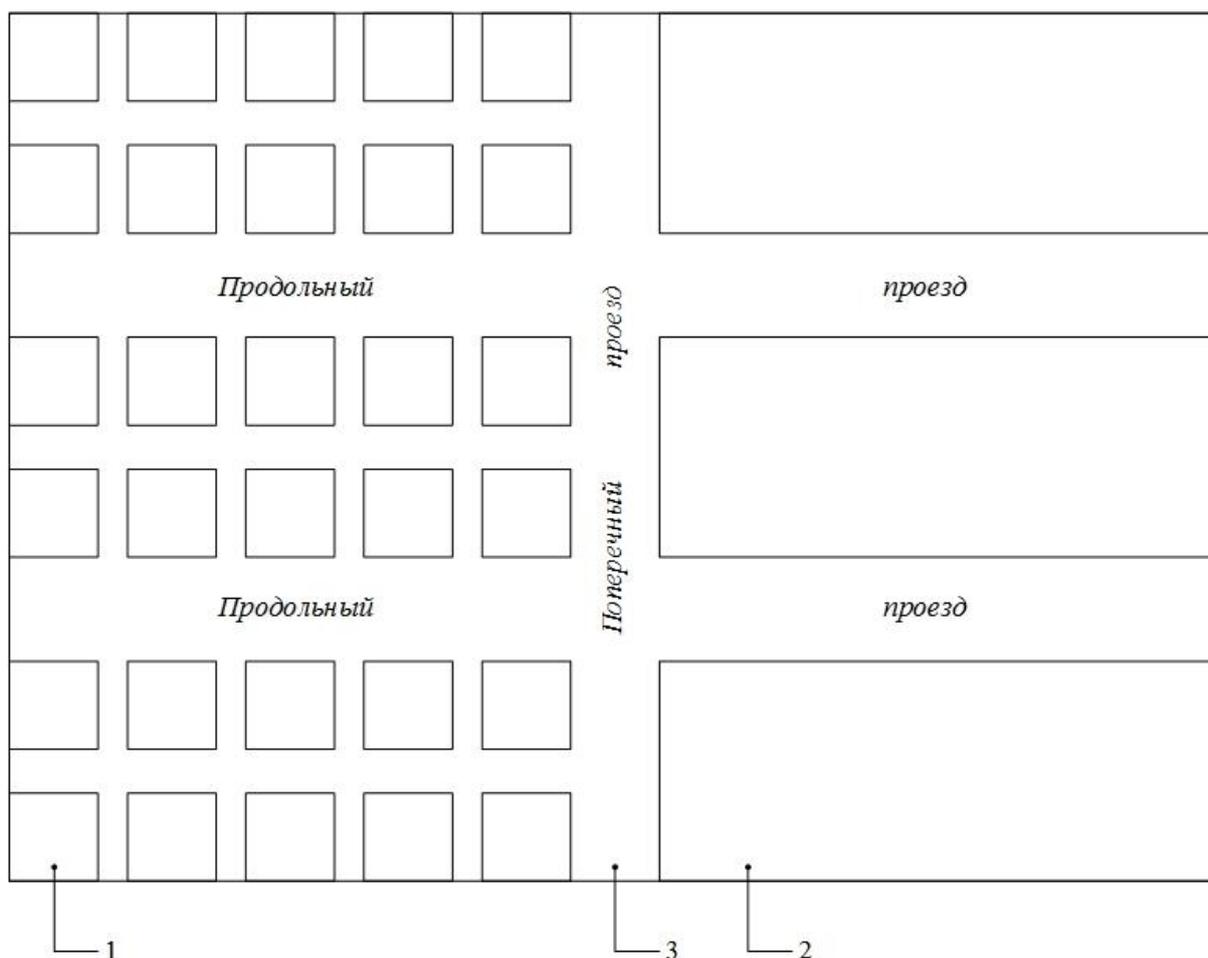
Планировка групп рядовых штабелей пиломатериалов при открытом хранении:
